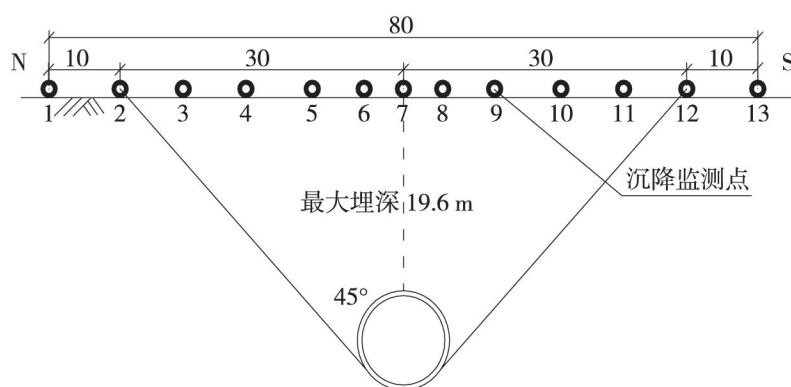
地表沉降监测点断面布置 (单位: m)
